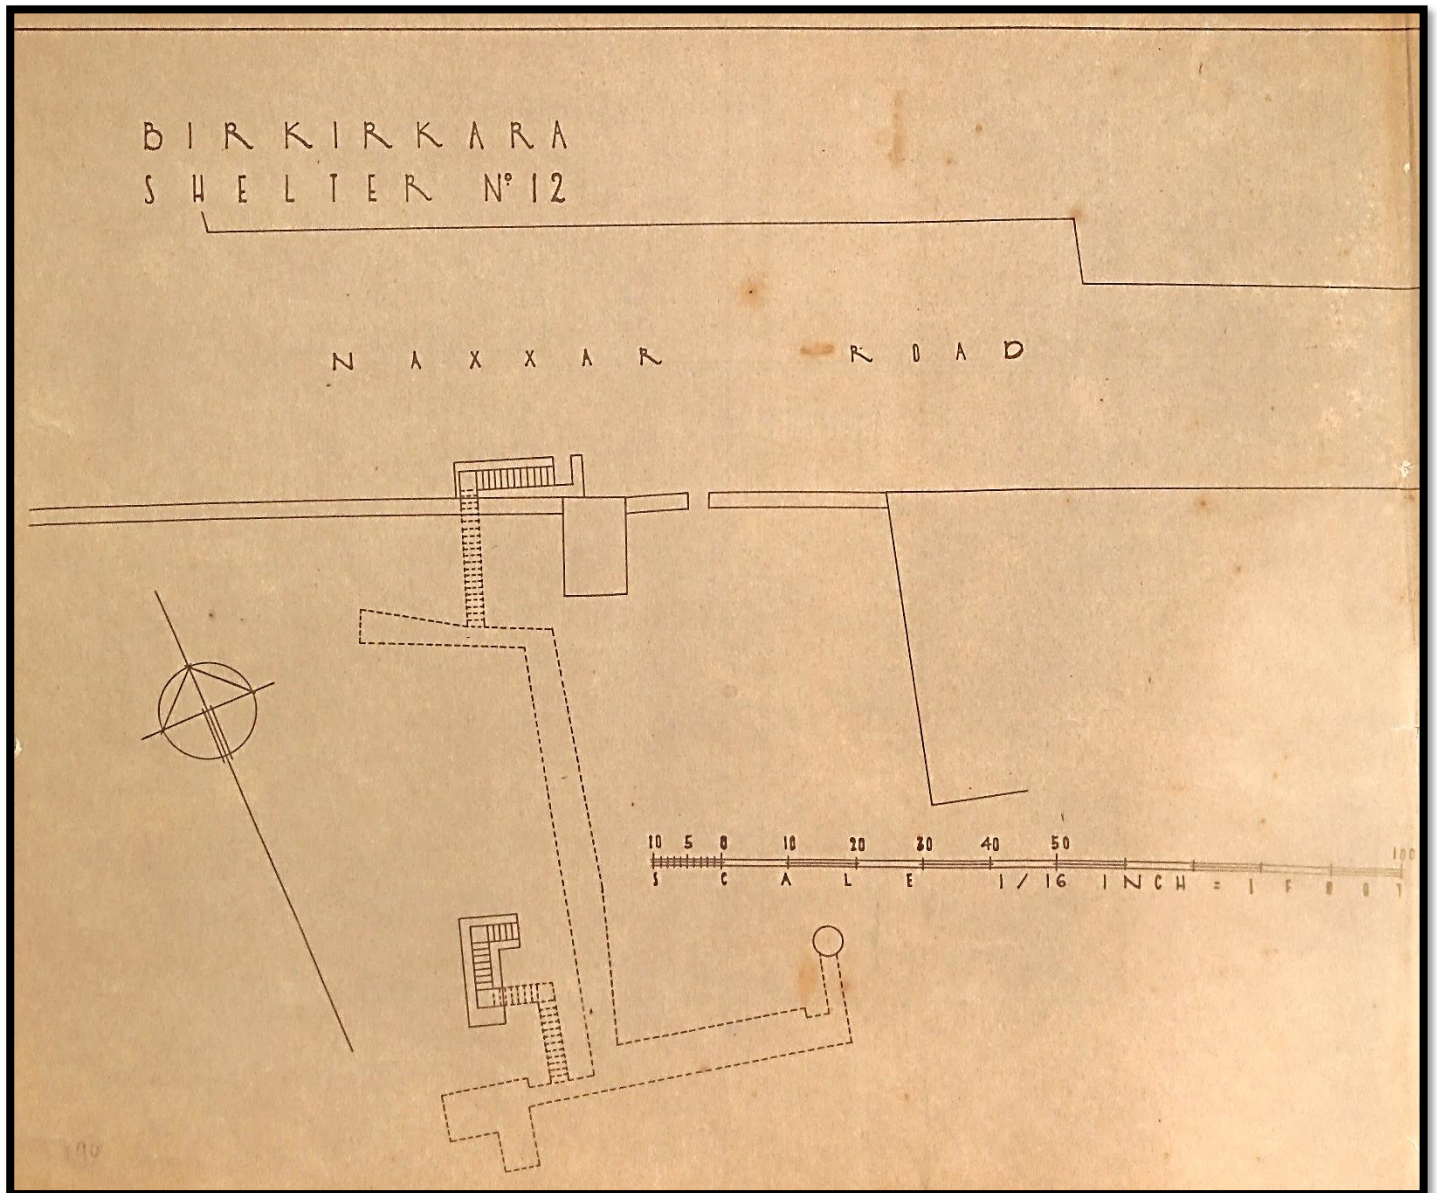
Planta do Abrigo nº 12 "Naxxar Road"
